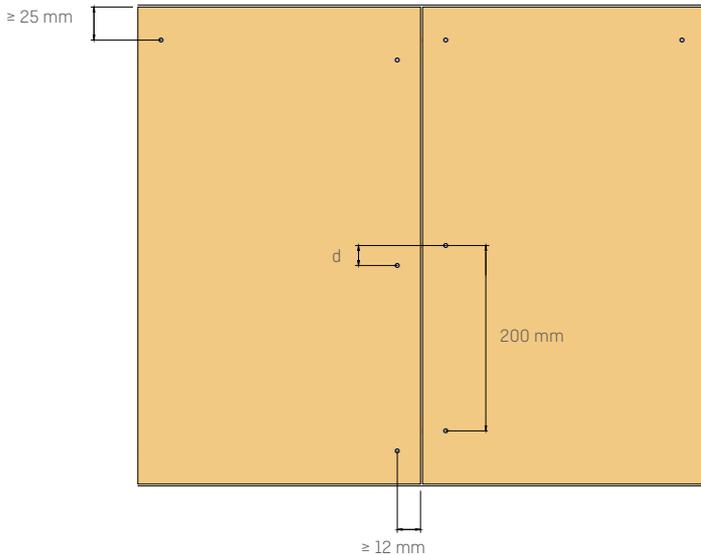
Fijación de los paneles a los perfiles metálicos
